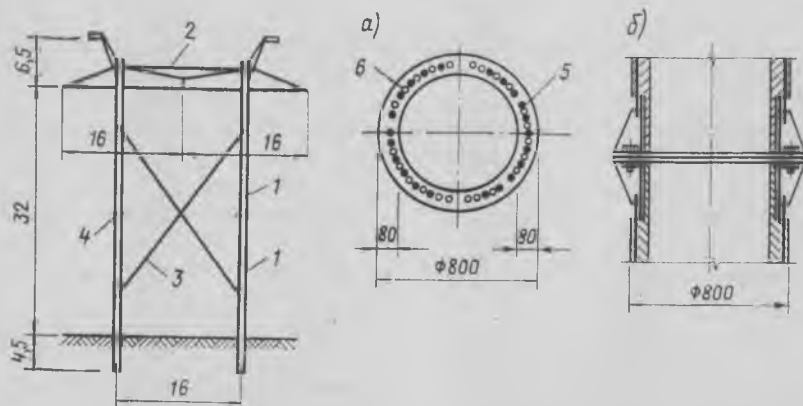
Схема железобетонной опоры для линий напряжением 750 кВ
